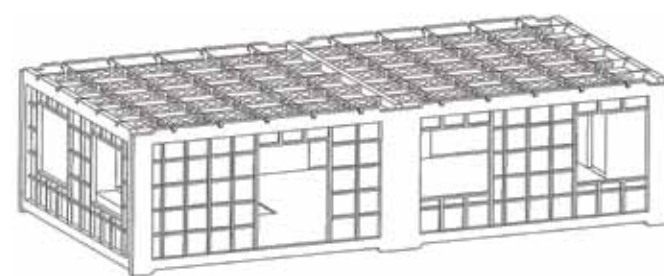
Общий вид мобильного крупногабаритного модуля в сборе (элементы теплоизоляции, перегородки и сантехкабины условно не показаны)
